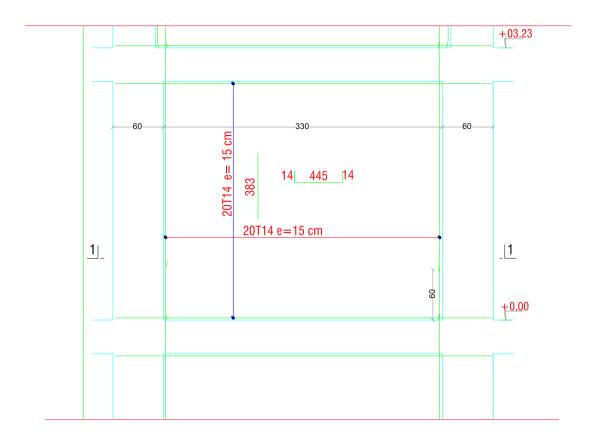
Coupe verticale de Ferraillage des voiles au niveau de RDC.
